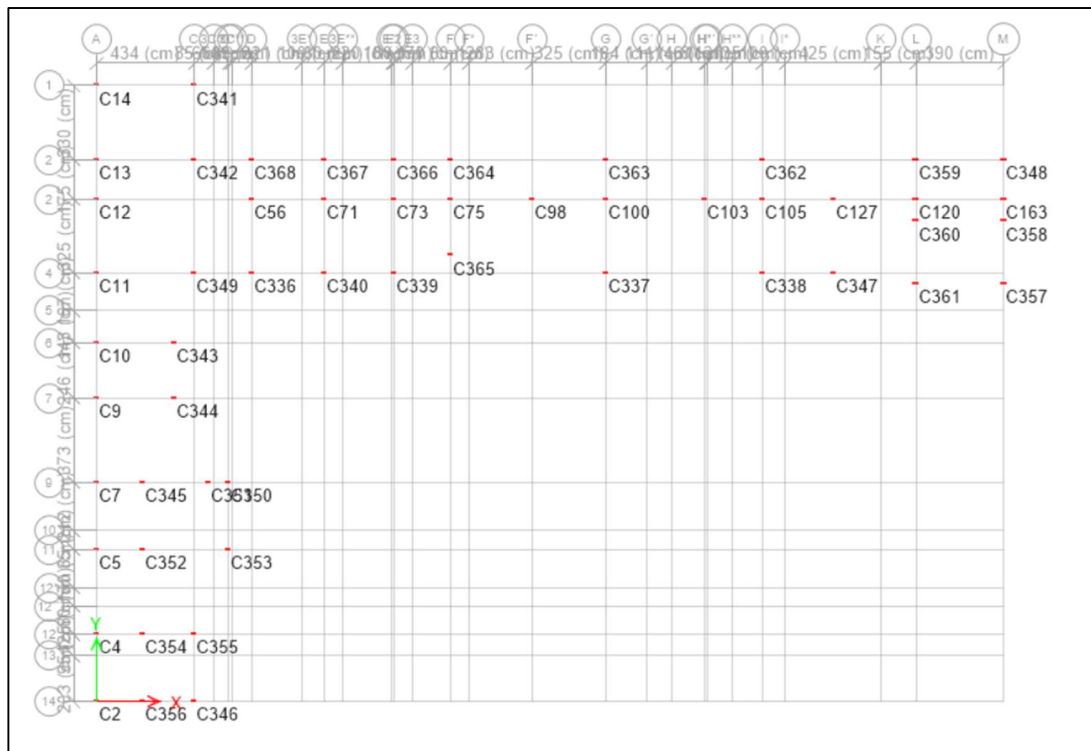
COLUMNAS CUBIERTA (A 3,6 M)
